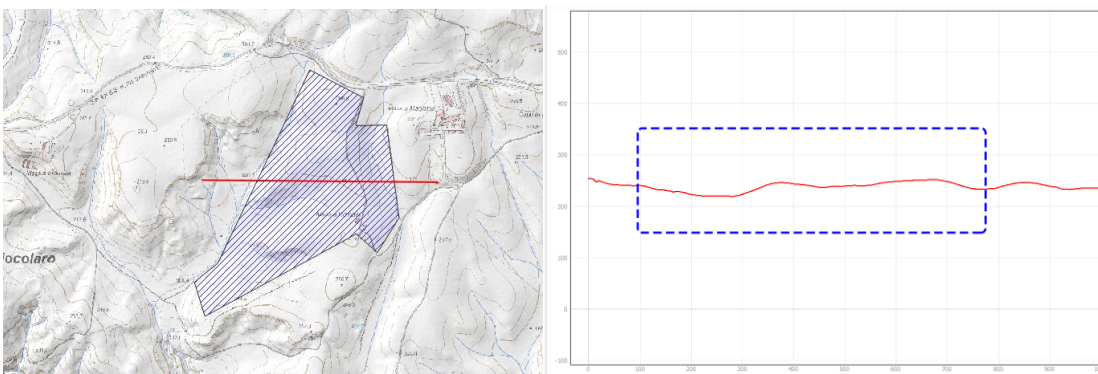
sezione longitudinale (in scala) all'impianto di progetto (blu – area impianto)
